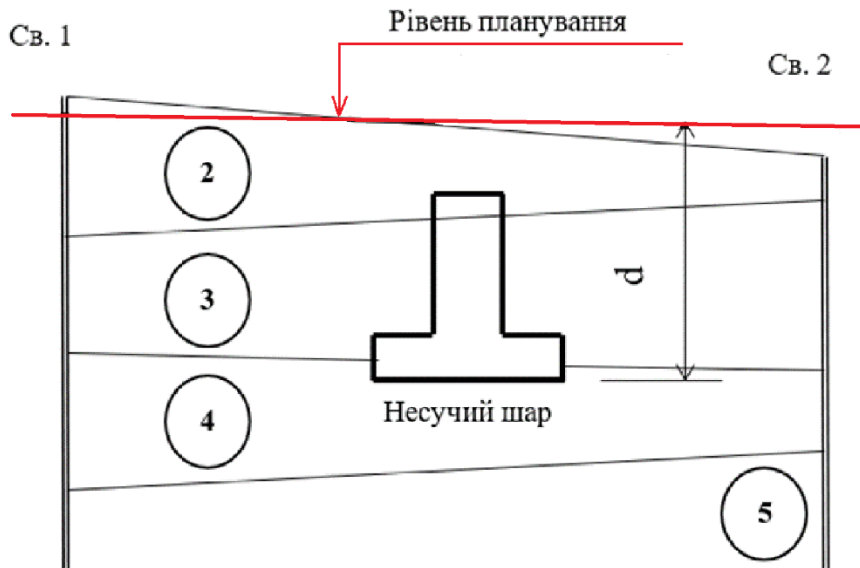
Встановлення несучого шару ґрунтової основи фундаменту, що проектується
